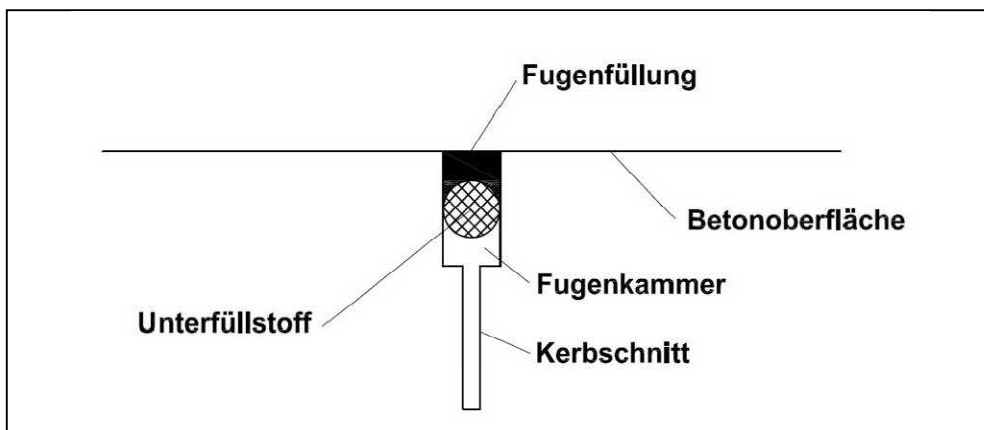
Prinzipskizze einer Fuge mit Baustahlbewehrung im Bestand
